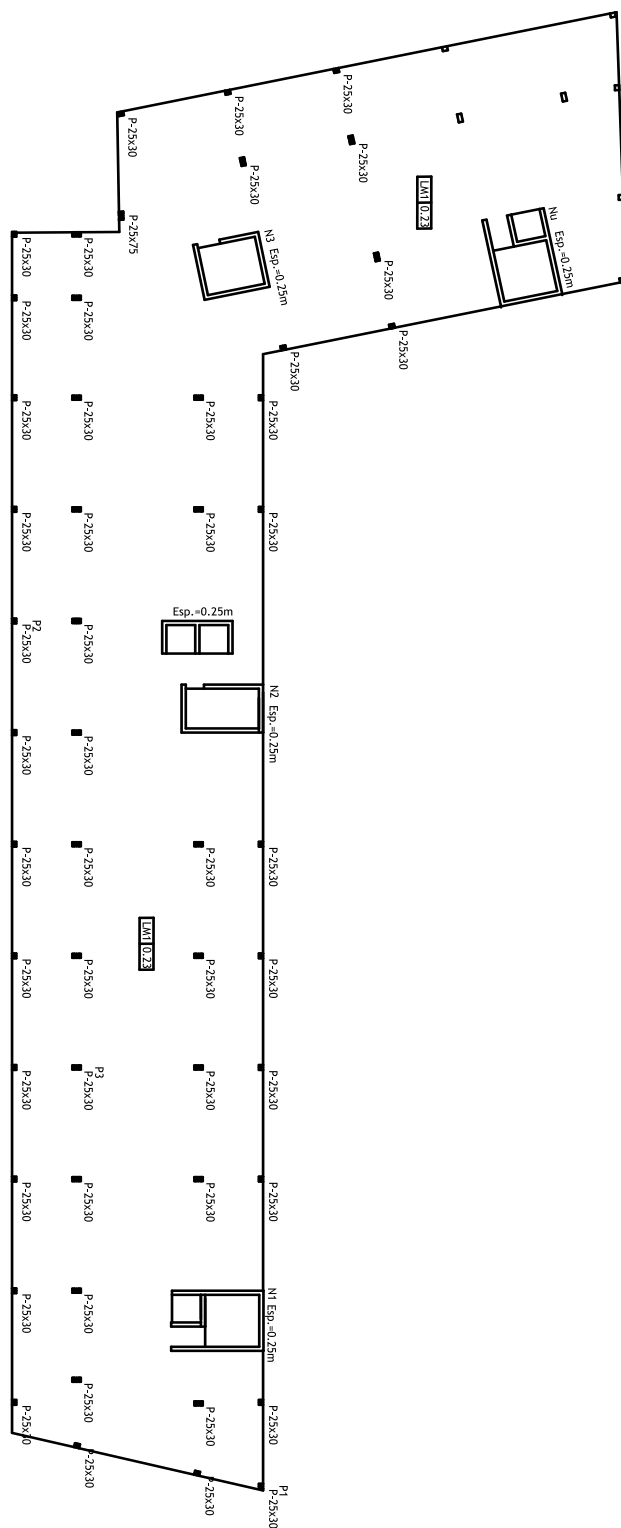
Edifício real: planta estrutural do piso 5
